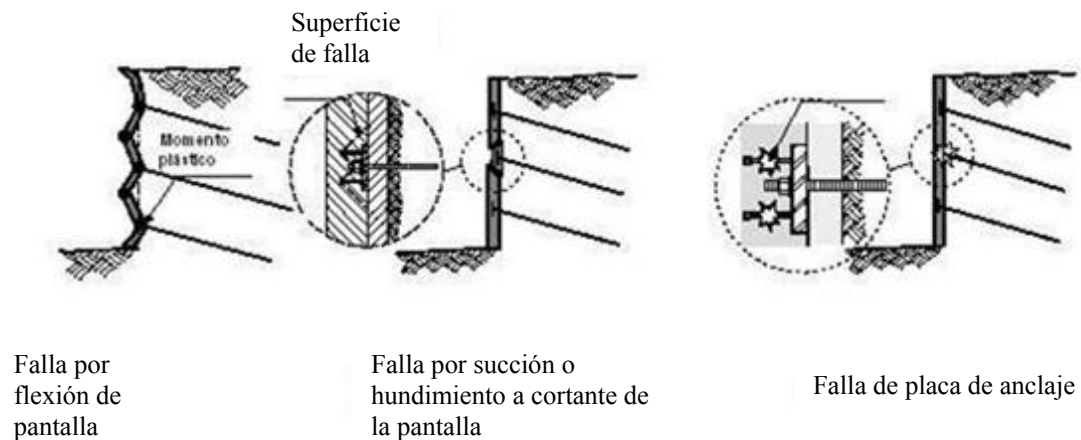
8 Tipos de falla de pantalla en muros de soil nailing.
